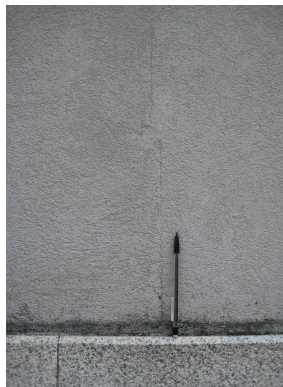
Fissuração vertical nas juntas entre perfis de arranque [33]
